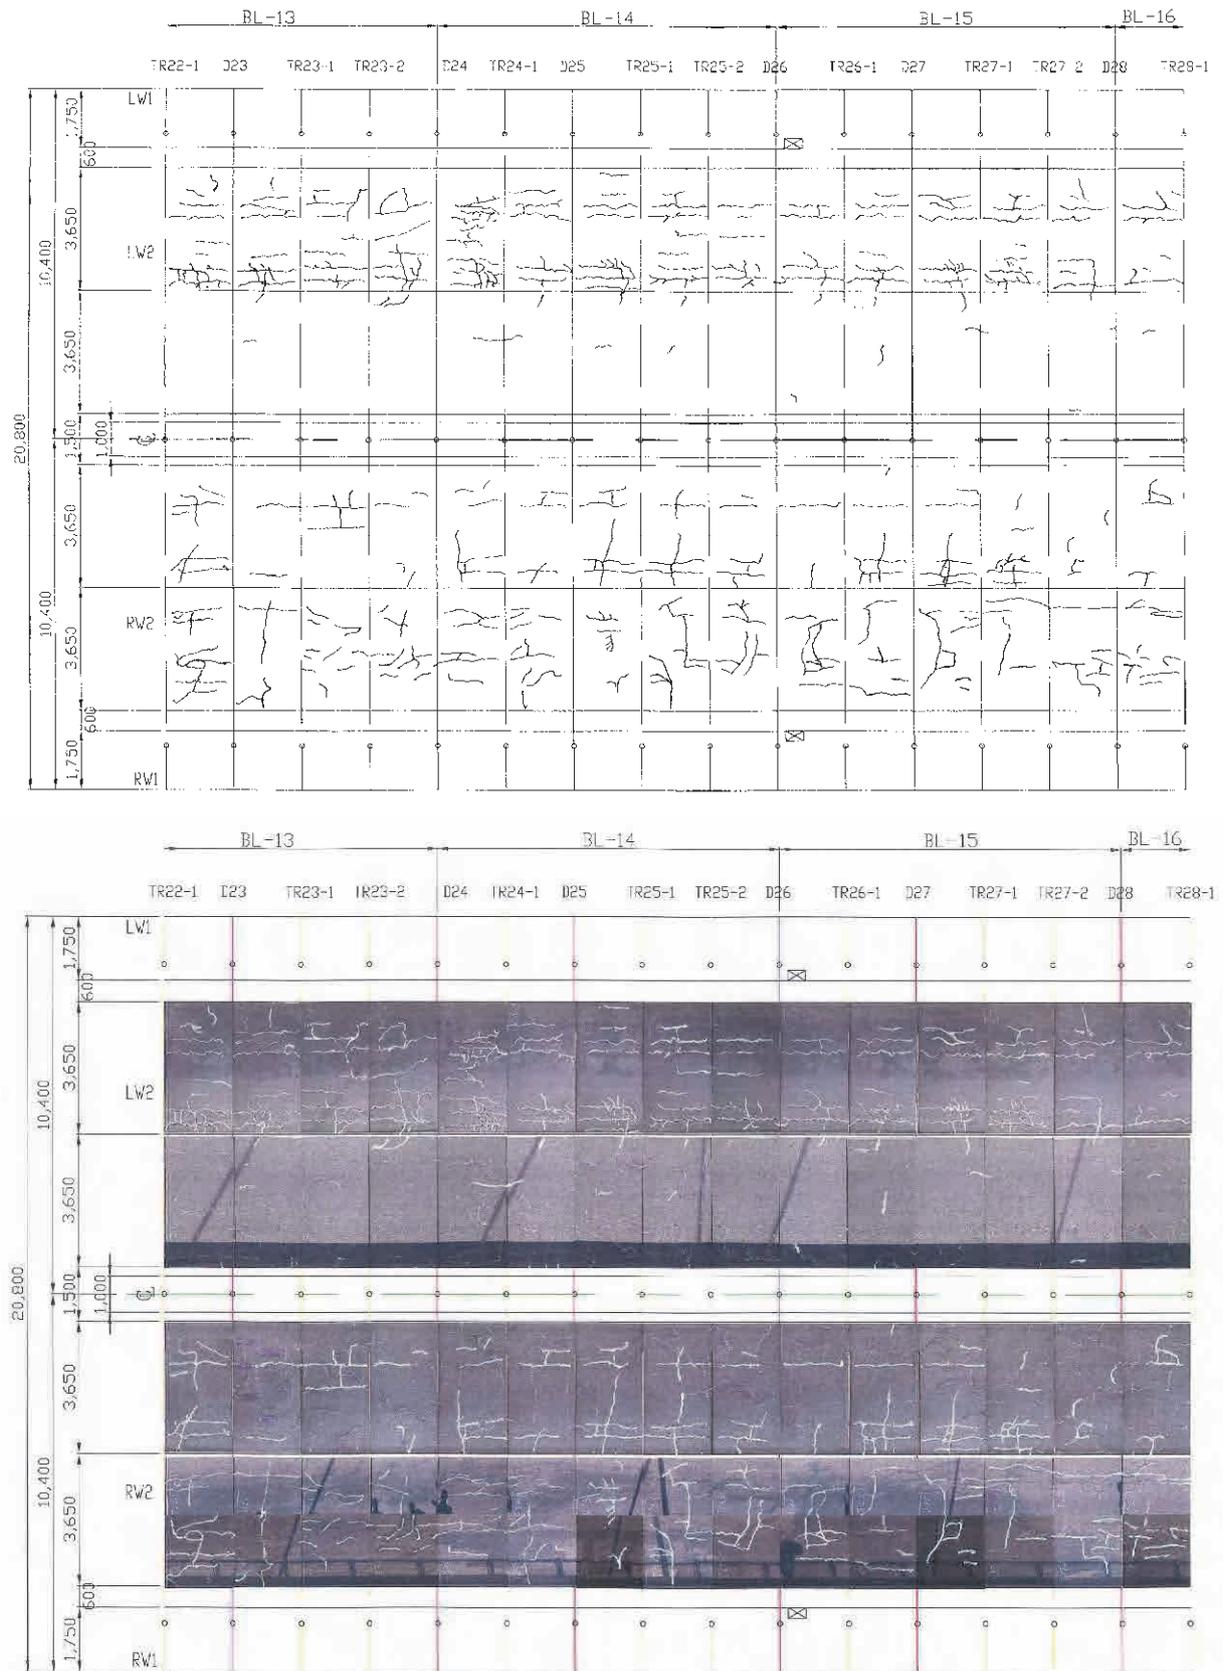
鋼床版舗装のひび割れの状況（抜粋）
